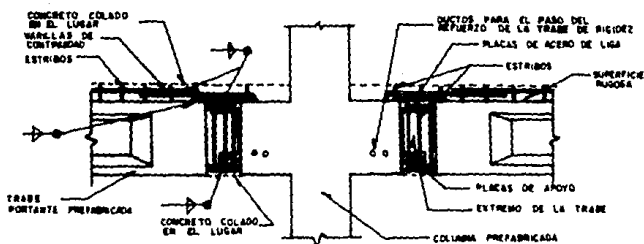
Detalle de los elementos de conexión en columnas interiores.
